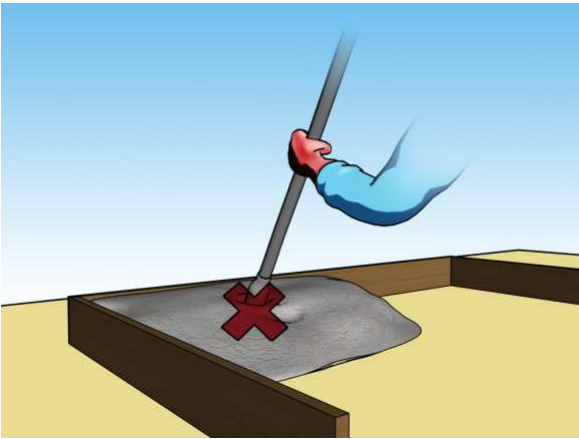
Kütlesi beton işlerinde beton eşit tabakalar halinde dökülmelidir. Aksi halde betonun sıkıştırılması çok zor olur.
